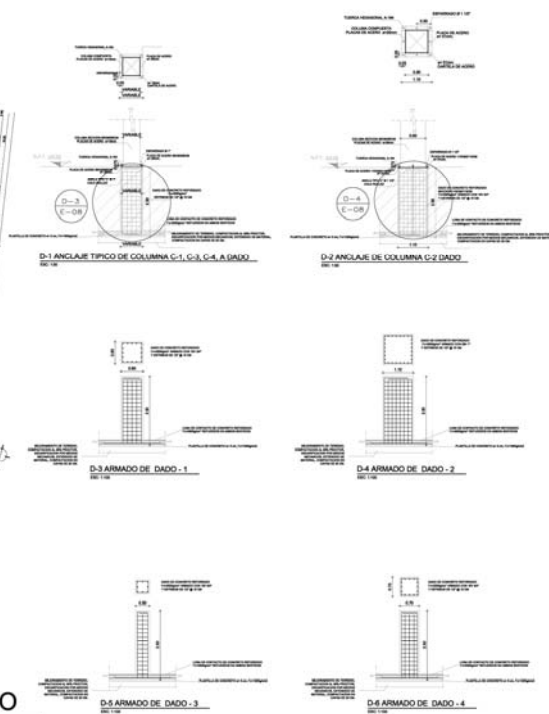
PLANO ESTRUCTURAL – SECCIÓN ESTRUCTURAL BIBLIOTECA – E-05. Fuente: Elaboración propia.
